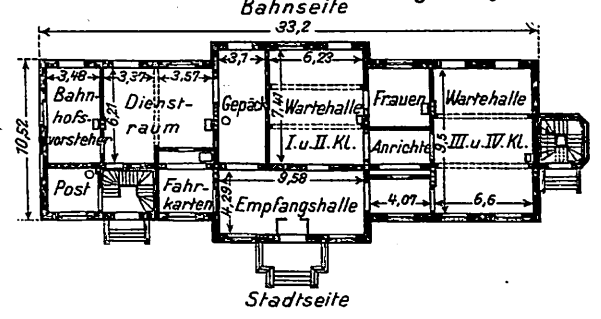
Erdgeschoß nach dem Um- und Erweiterungs-Baue.
